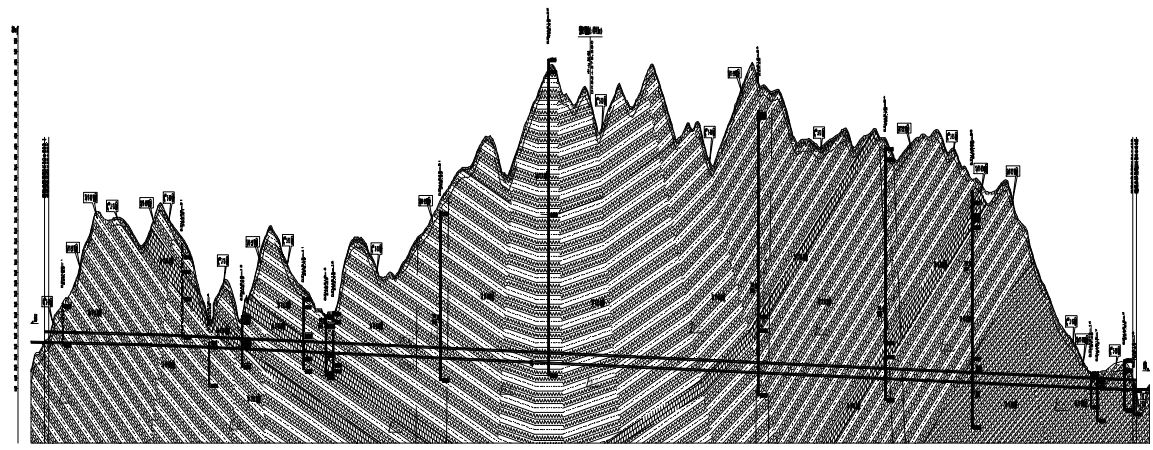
马鞍山 1 号隧道纵断面示意图
